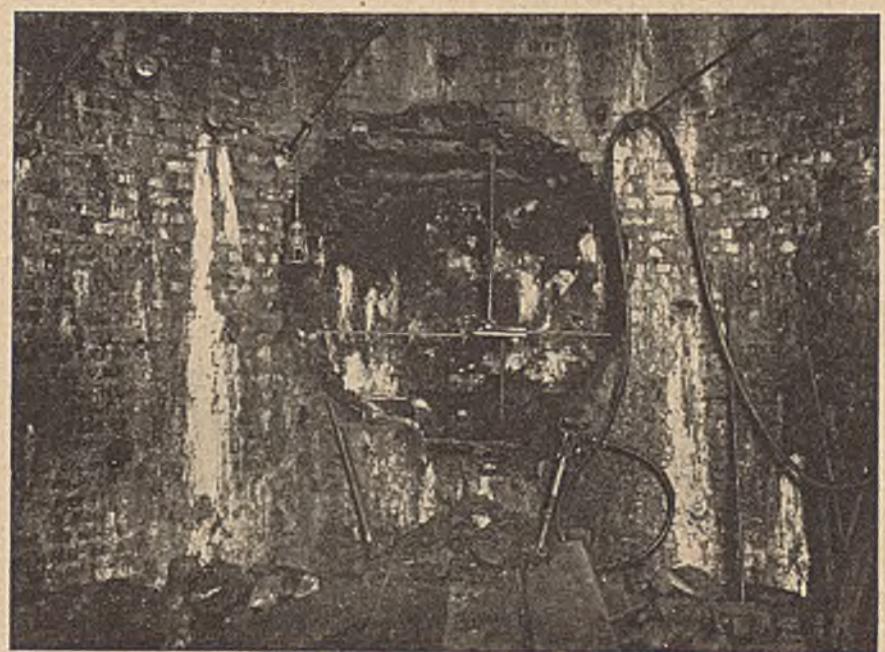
a. Wasserwerk Düsseldorf. Herstellung eines begehrbaren Kanals nach Verfestigung des Erdreiches von dem Brunnen schacht aus.
